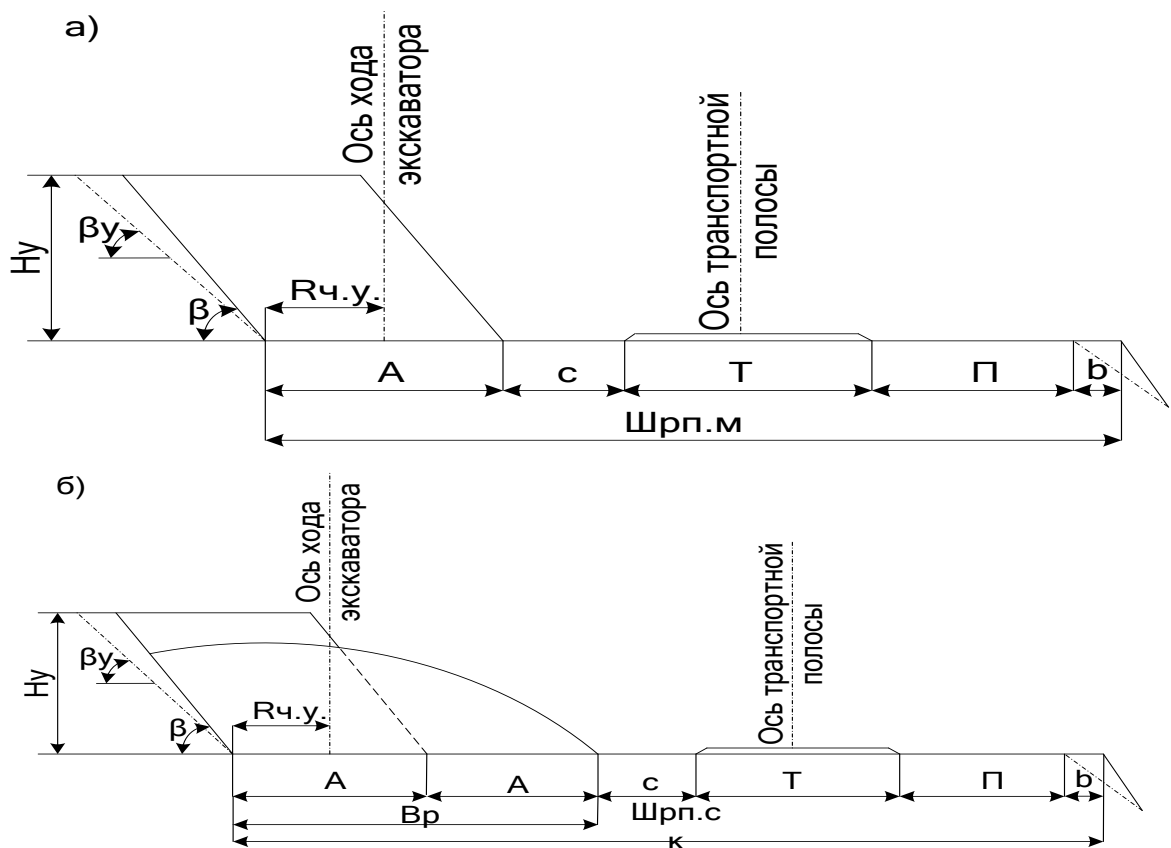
Схема к расчету ширины рабочей площадки:
